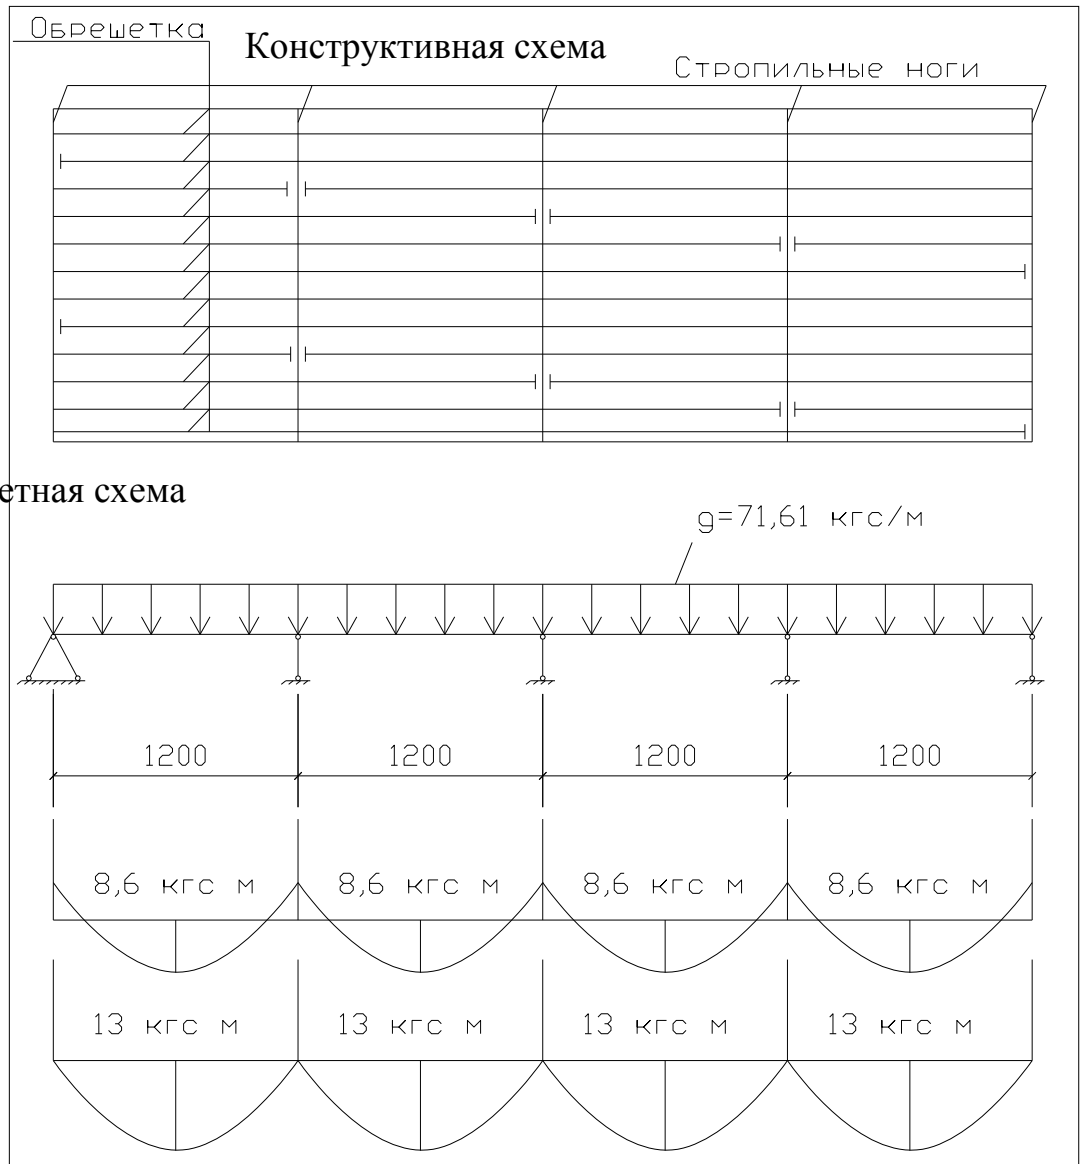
Схема нагрузок на стропильные ноги.
